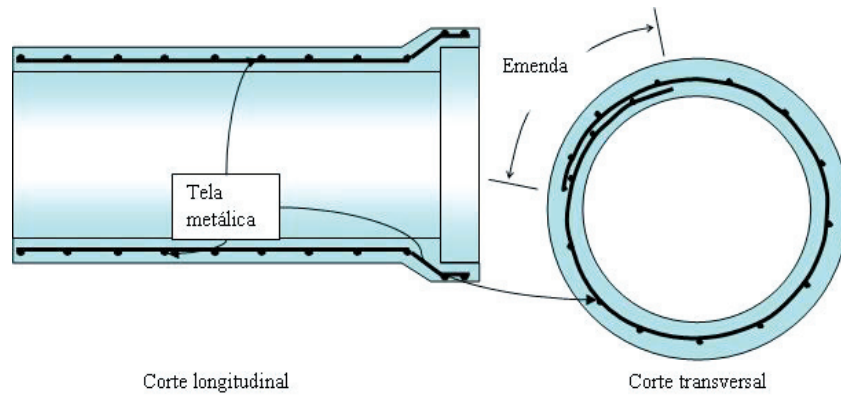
Posicionamento de armadura simples com tela soldada em um tubo com ponta e bolsa
